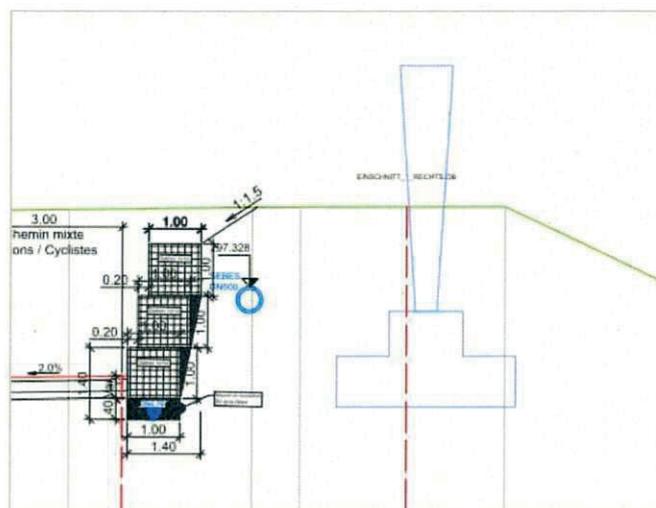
Mise en place du blindage pour les fondations des piles P2 et P3
